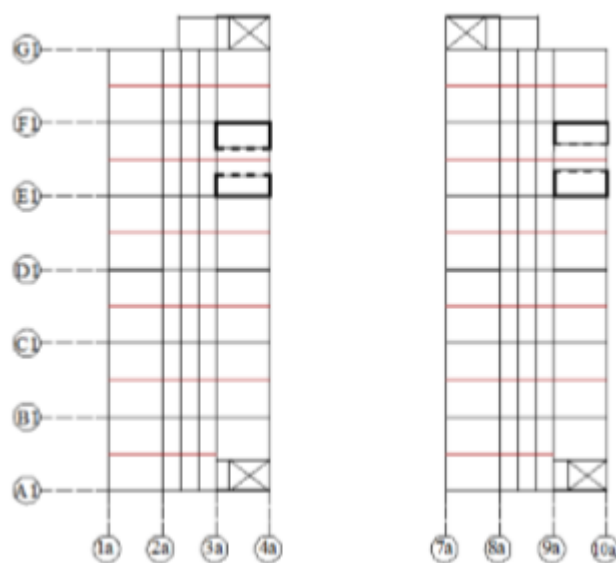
Denah Lantai 2 – 18 pada Struktur I
